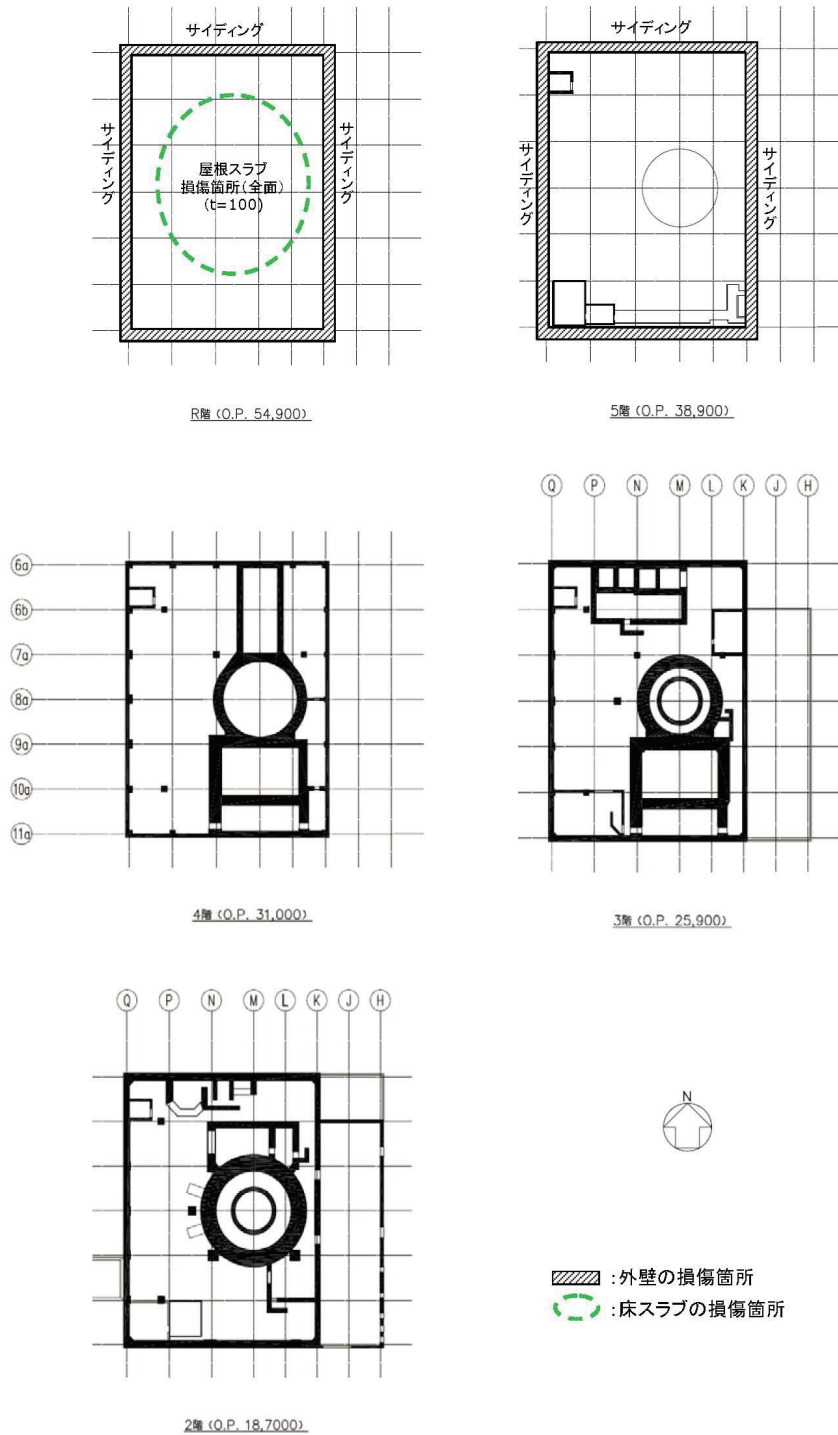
1号機原子炉建屋の損傷状況（平面図）
